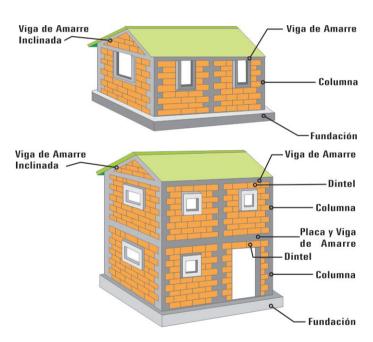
Disposición típica de columnas y vigas de amarre en casas de 1 y 2 pisos.
